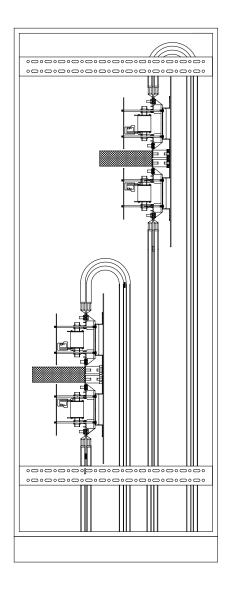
Allacciamento cavi in arrivo dalle String Box: vista laterale
